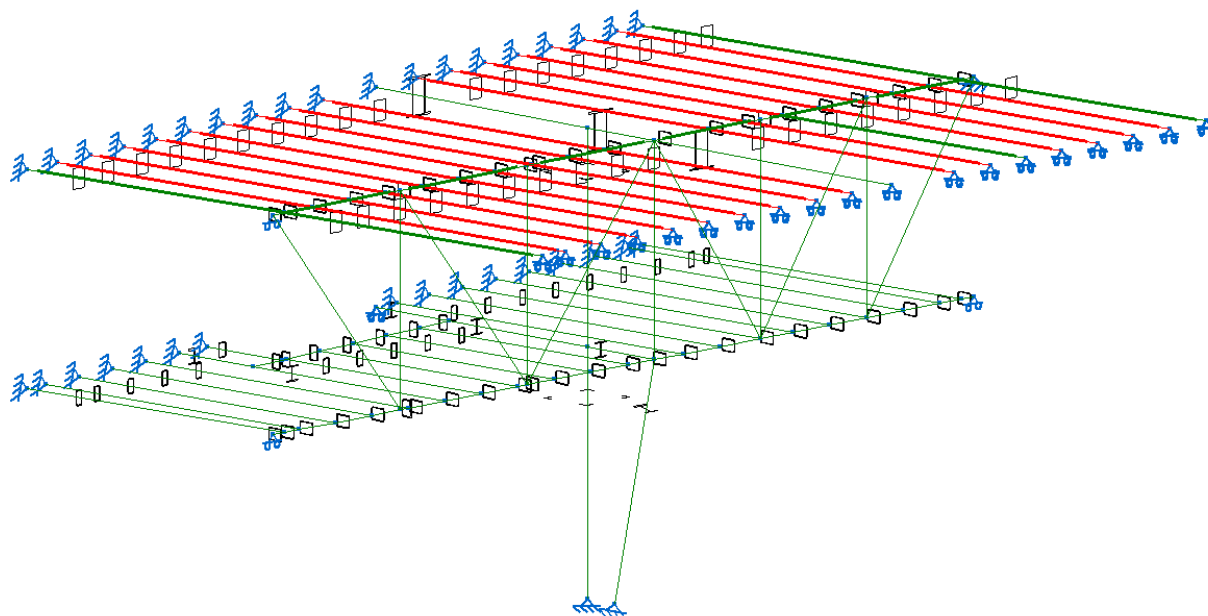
Comprobación de elementos de la estructura de planta alta y entreplanta
